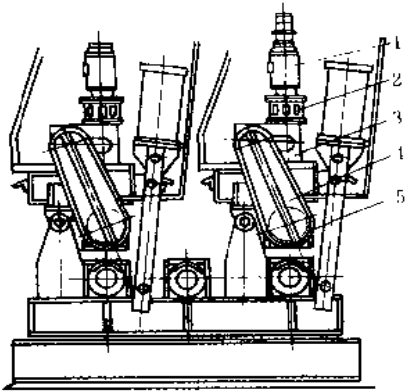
采用圆锥-圆柱齿轮减速器传动的方坯拉矫机
